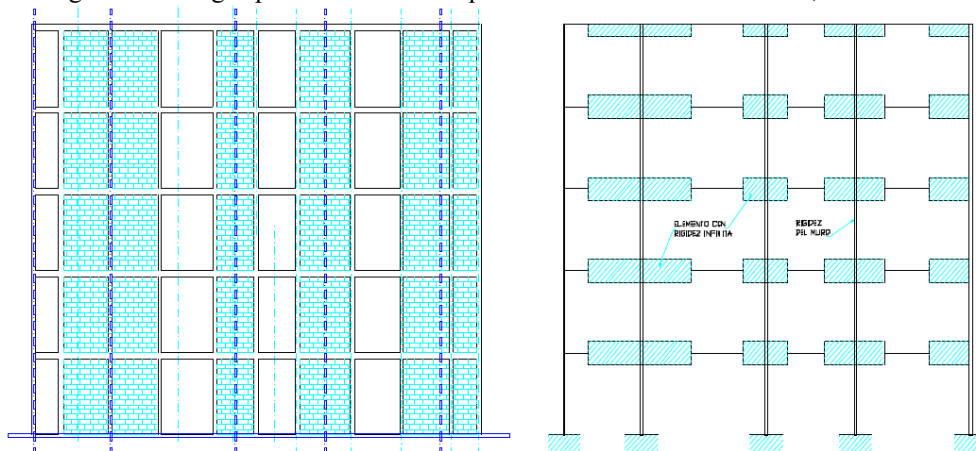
Especificaciones generales para mampostería reforzada interiormente.
